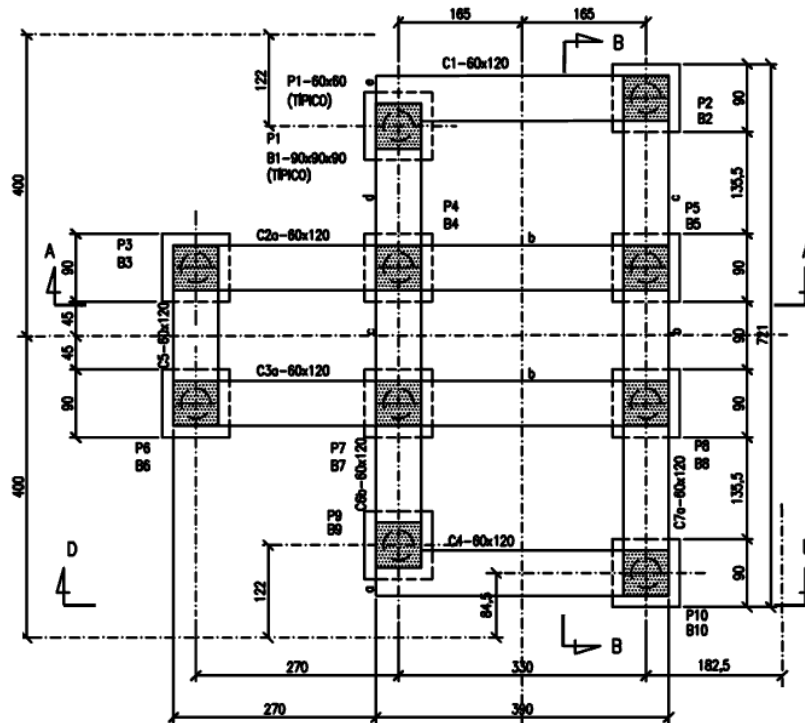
Planta no nível das fundações (elevação 99.8m)
